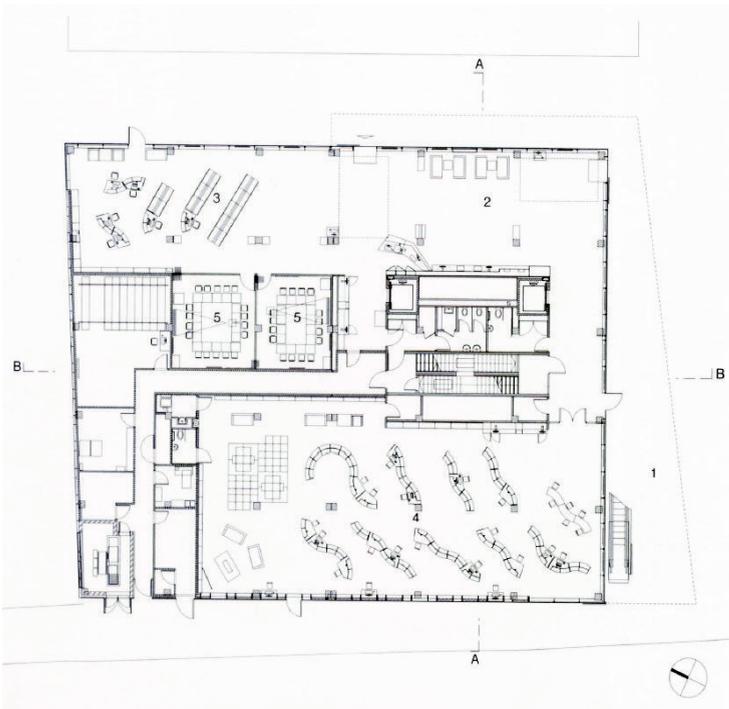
Grundriss Idea Store Whitechapel
